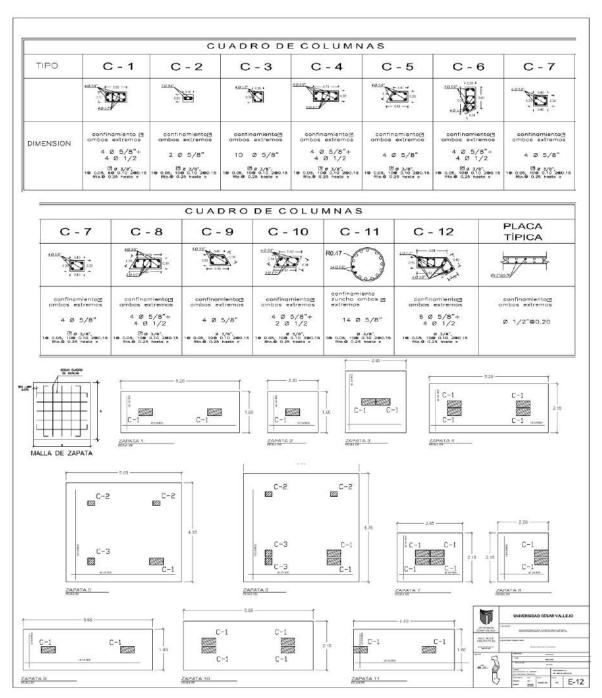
Cimentación - Detalles - ESTRUCTURAS
